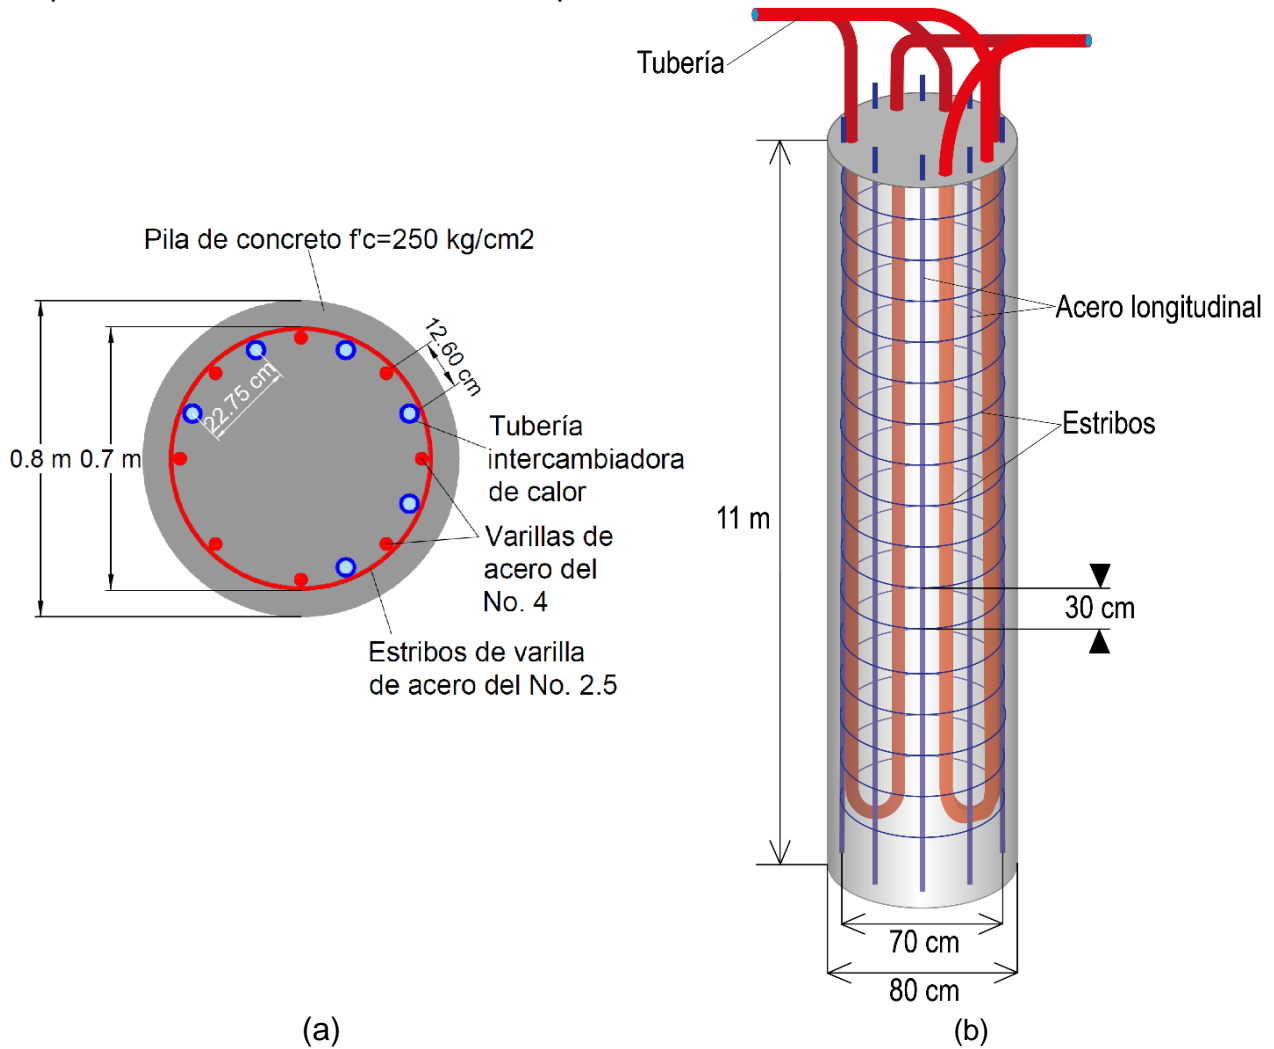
Esquema de la pila de energía con tubería de tres bucles en U: (a) Sección transversal; (b) Sección longitudinal
